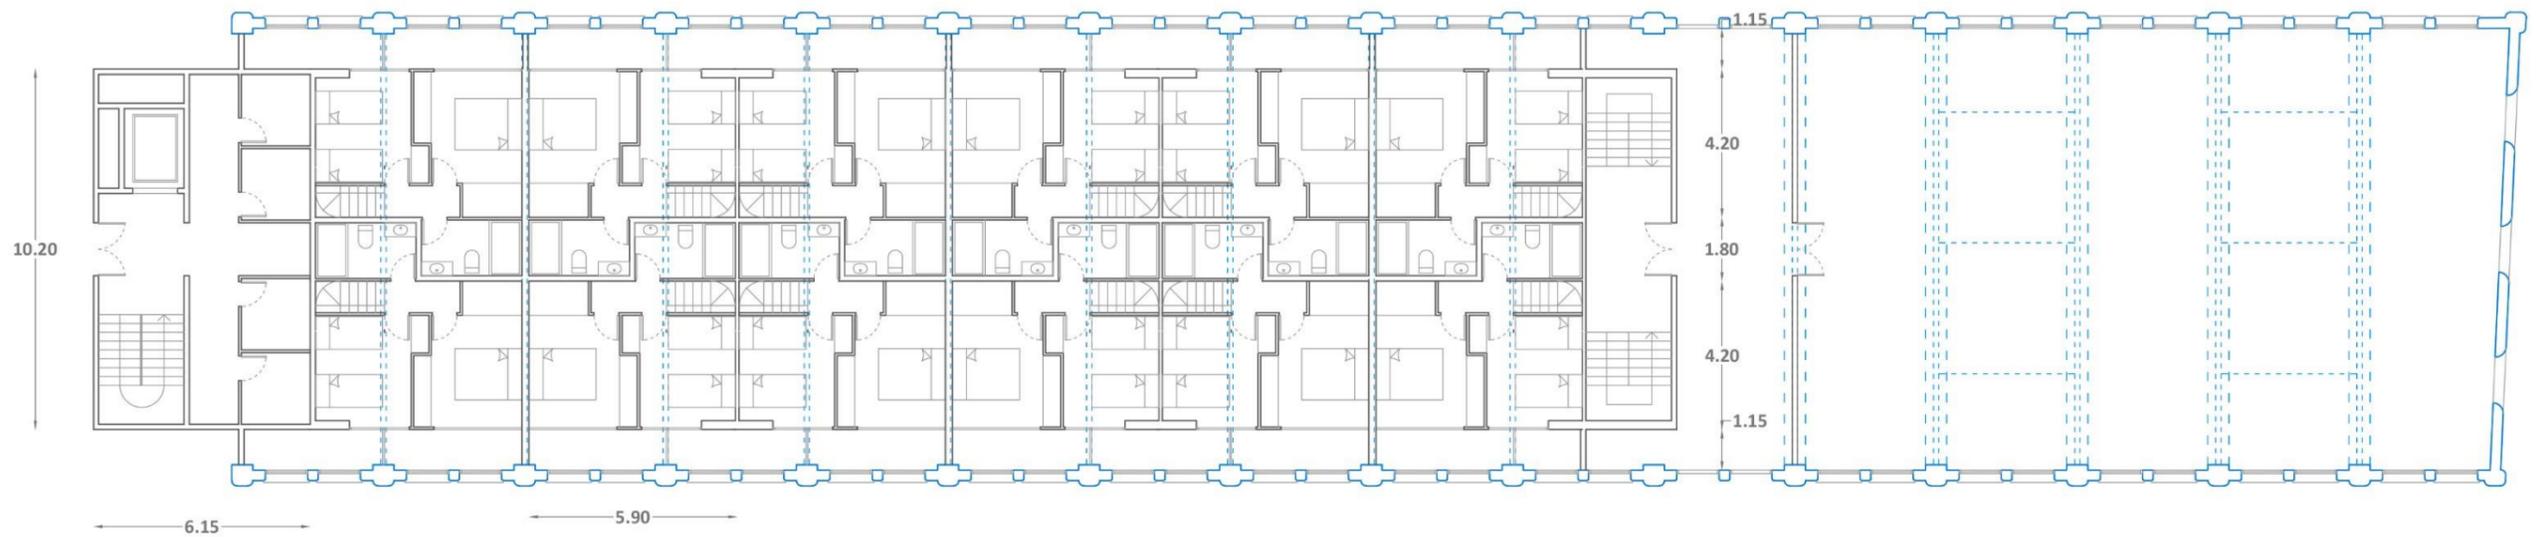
PLANO 1/200. Planta baixa intervenció fàbrica Pere Font i Batallé.
